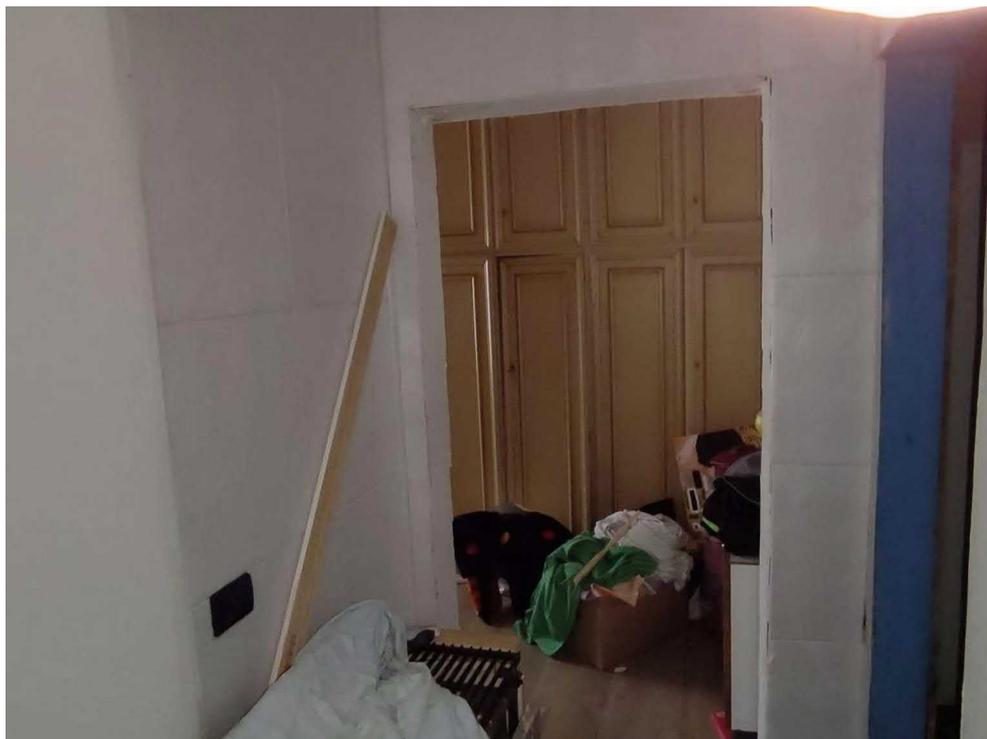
Piano secondo: scala di accesso al sottotetto.
